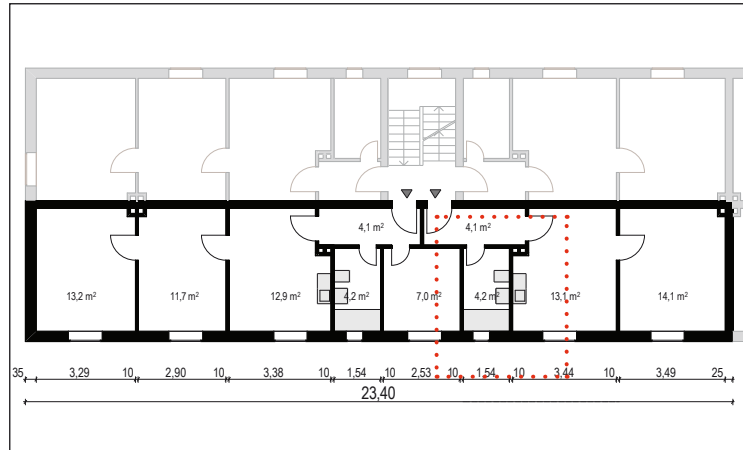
Beispielgrundriss Waldkraiburg, Kirchenstraße 2, Altbestand mit Baddetail
